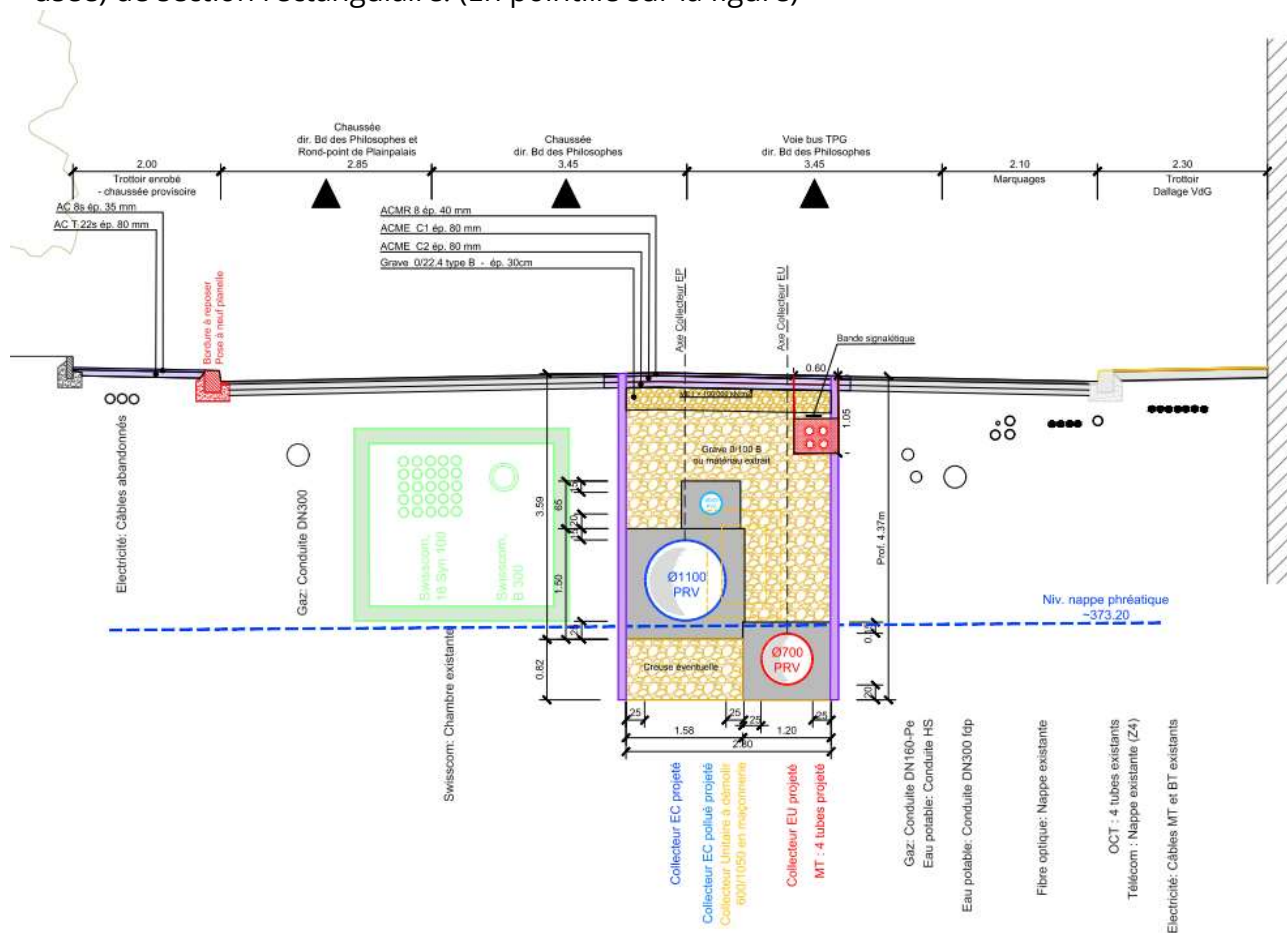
Coupe de la fouille du BPDA (Plan SDIG)
